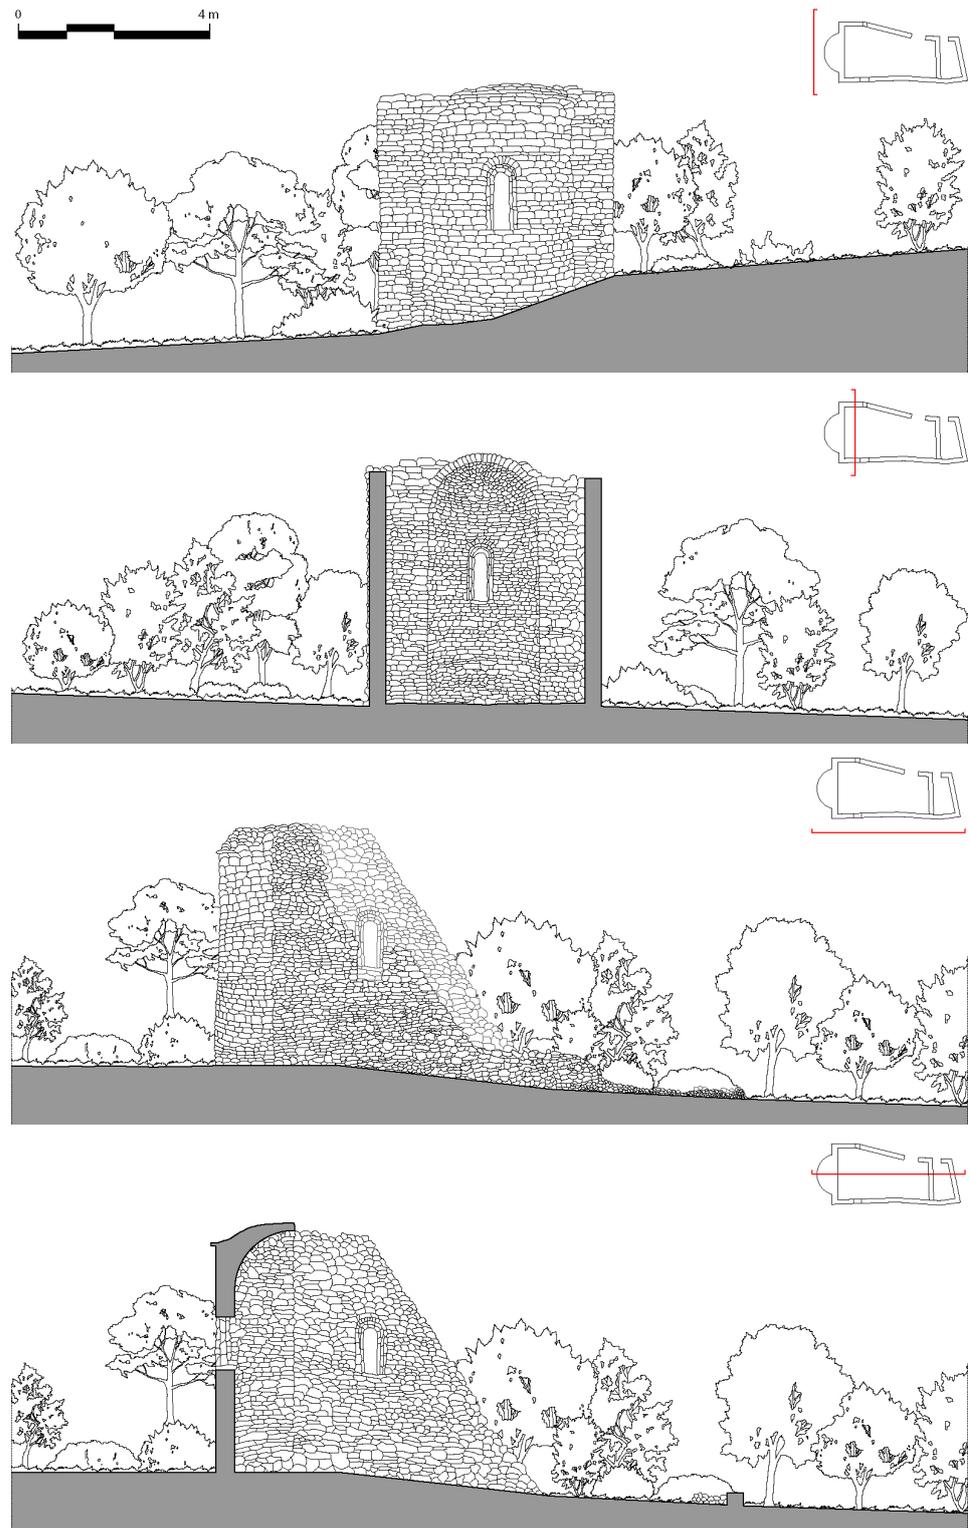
La Kisha Shen Pjetrit. Prospetto est, sezione trasversale, prospetto nord, sezione longitudinale. Elaborazione grafica degli autori.
